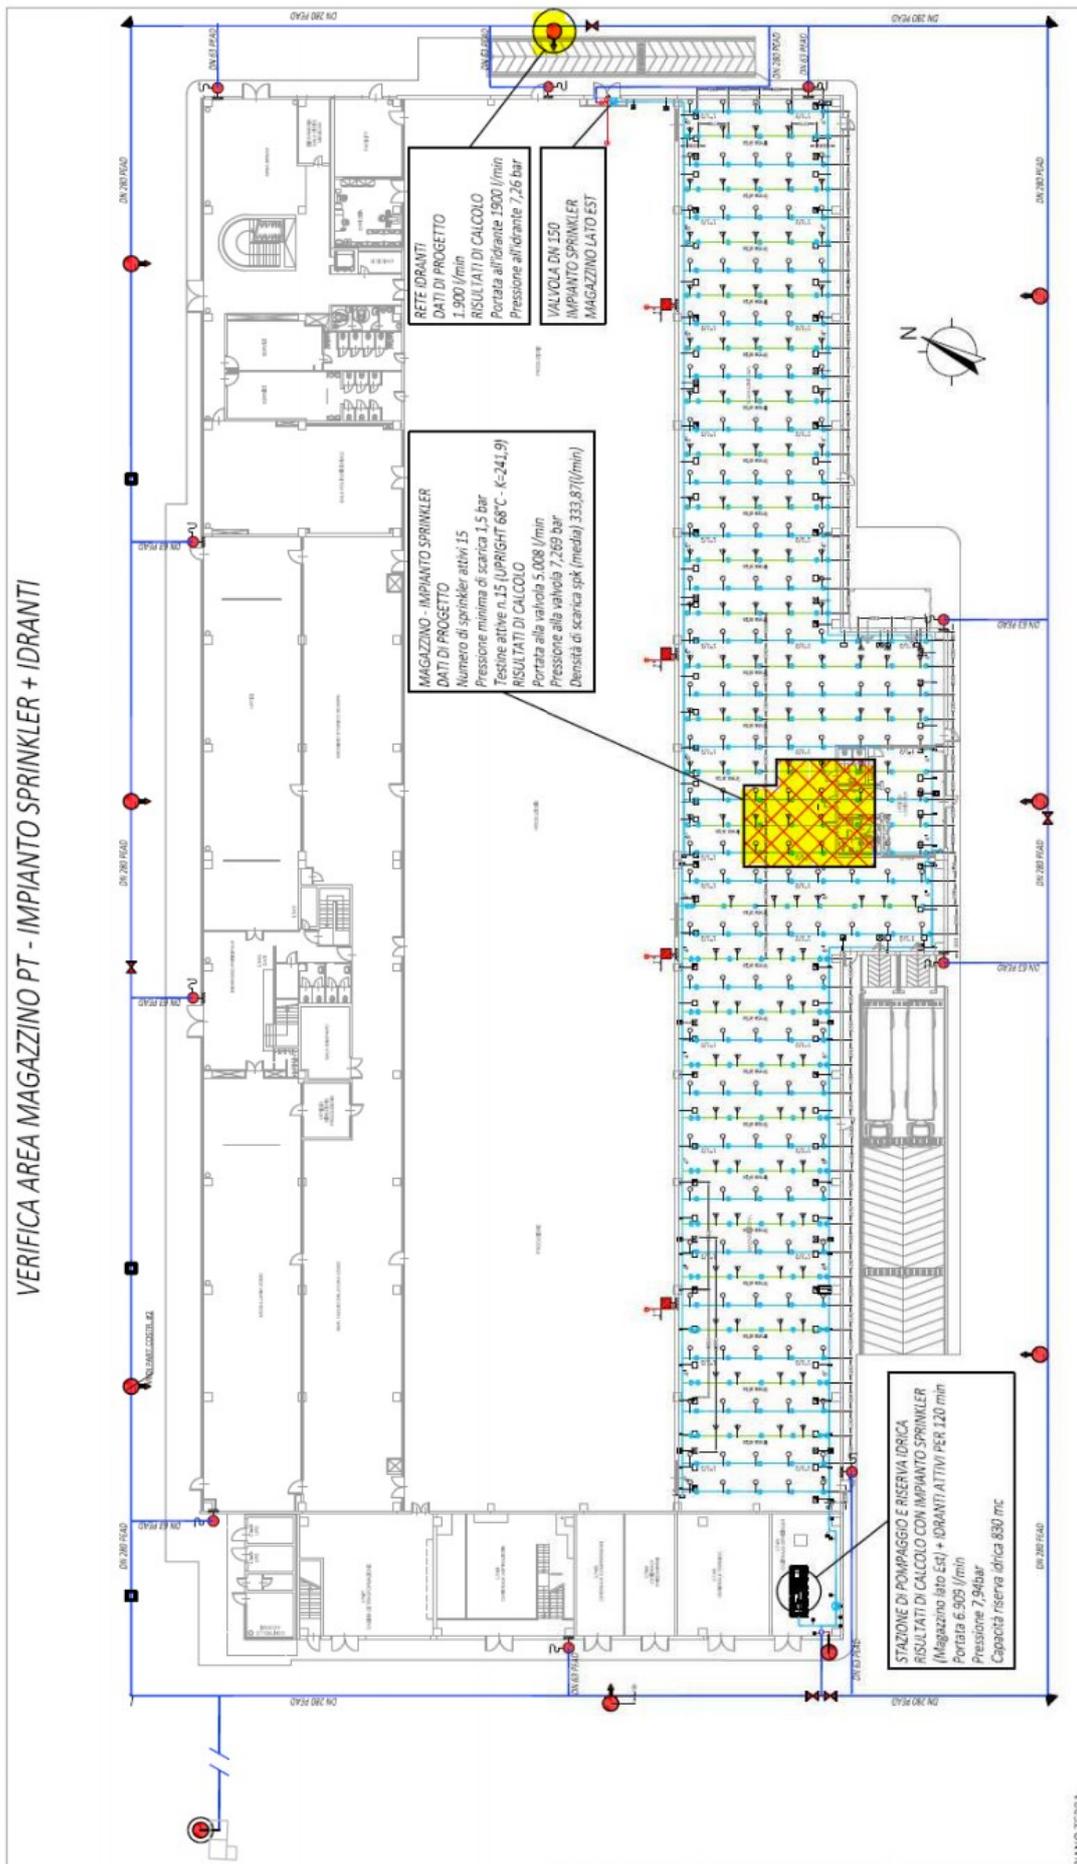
Planimetria area oggetto di verifica calcolo 1
